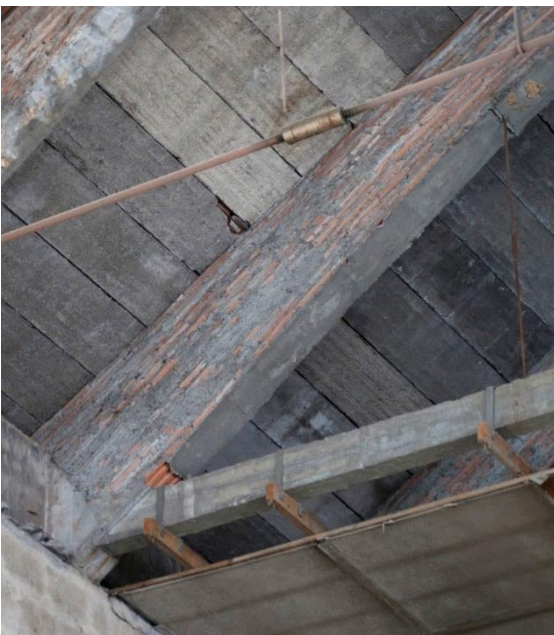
Detalle de un arco de la cubierta abovedada y el detalle constructivo. (Elaboración propia; AML 1963b)
